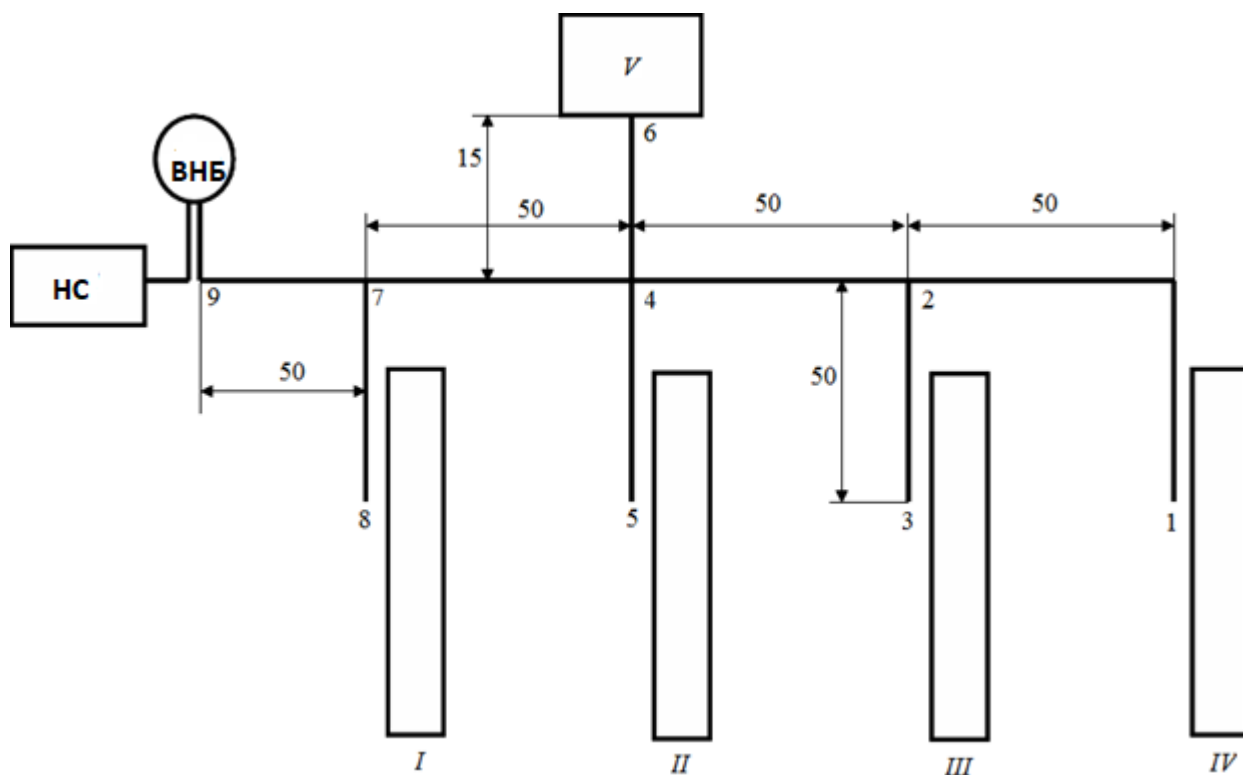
Схема водопроводной сети разводящей наружной фермы КРС
